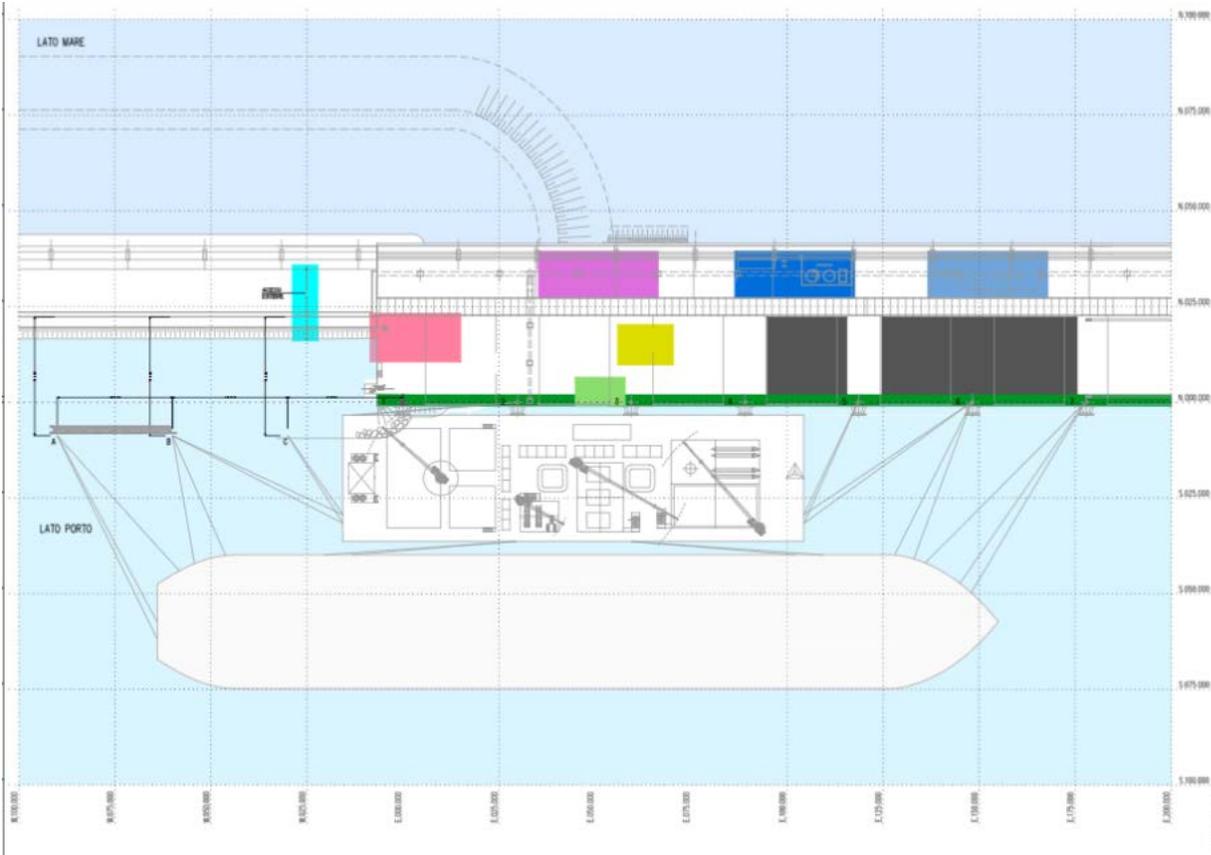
Planimetria Generale Aree Cantieri Operativi
